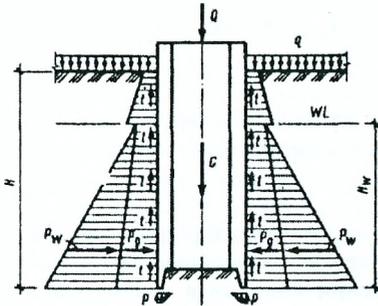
Схема нагрузок, действующих на опускной колодец во время его погружения
